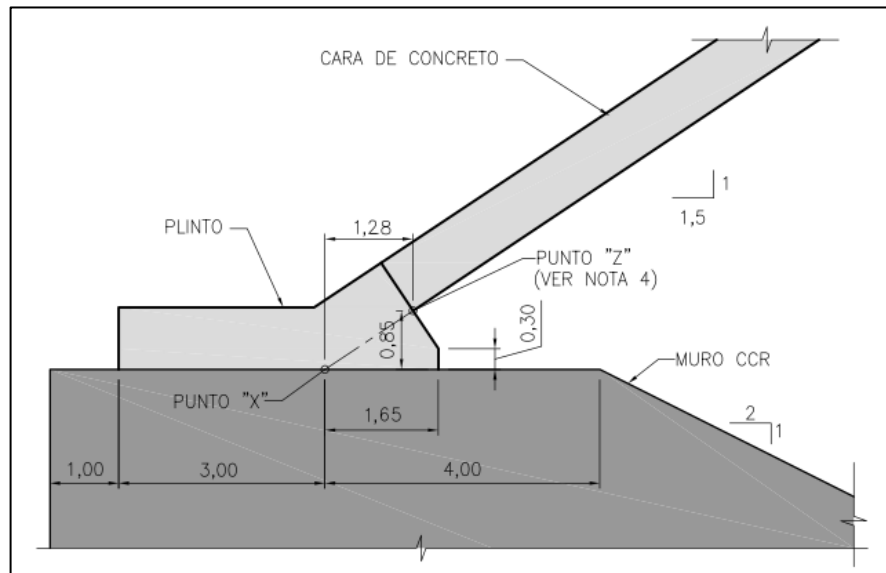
Corte transversal del plinto convencional – Proyecto Final
